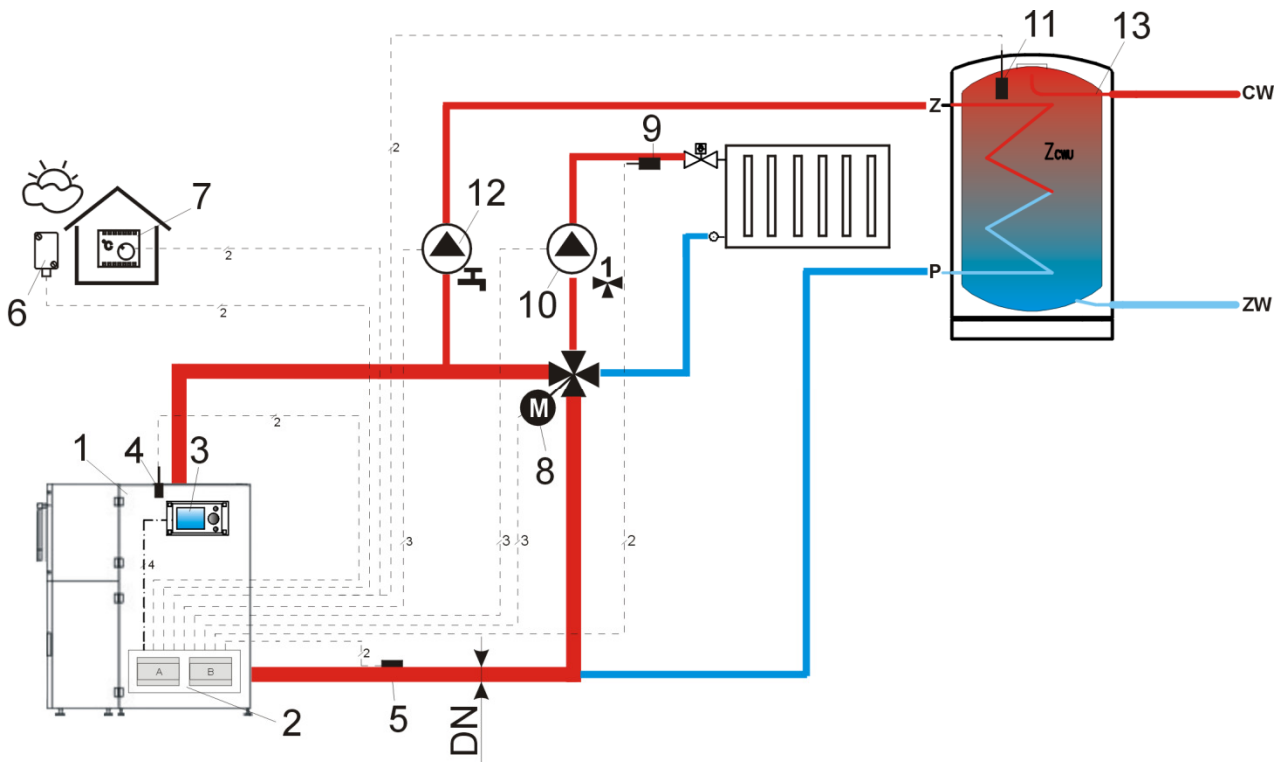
Schema mit 4-Wegeventil zur Steuerung des ZH-Kreislaufes<sup>2</sup>,
